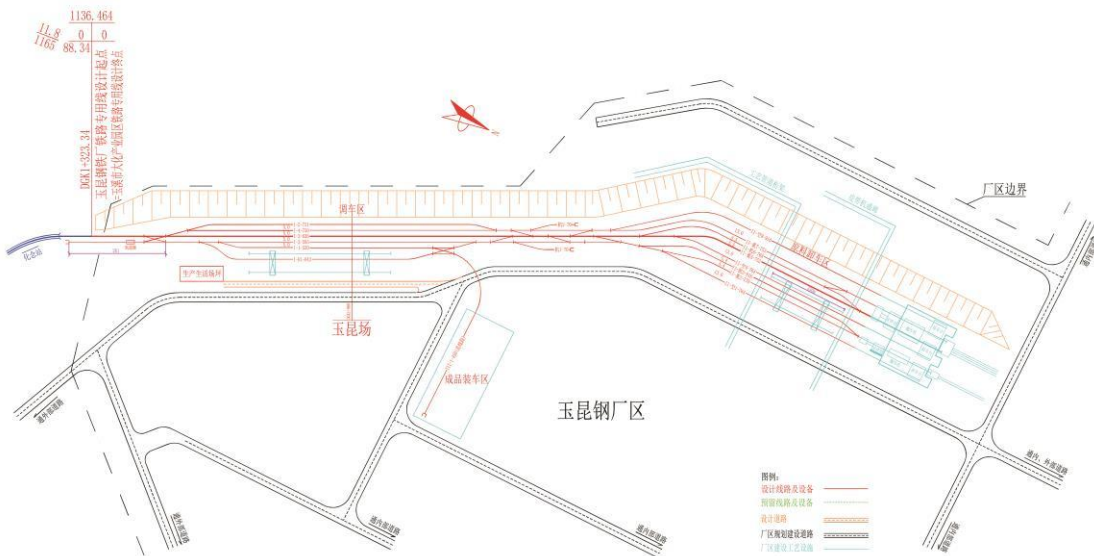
成品装车线由调车区顺接方案平面布置示意图
